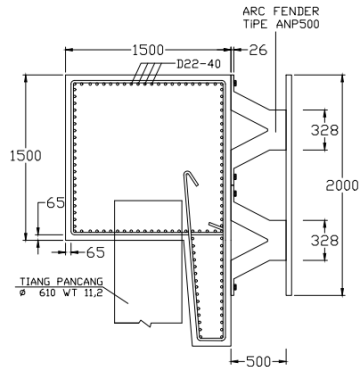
Detail Potongan Tampak Atas *Pilecap* Balok
